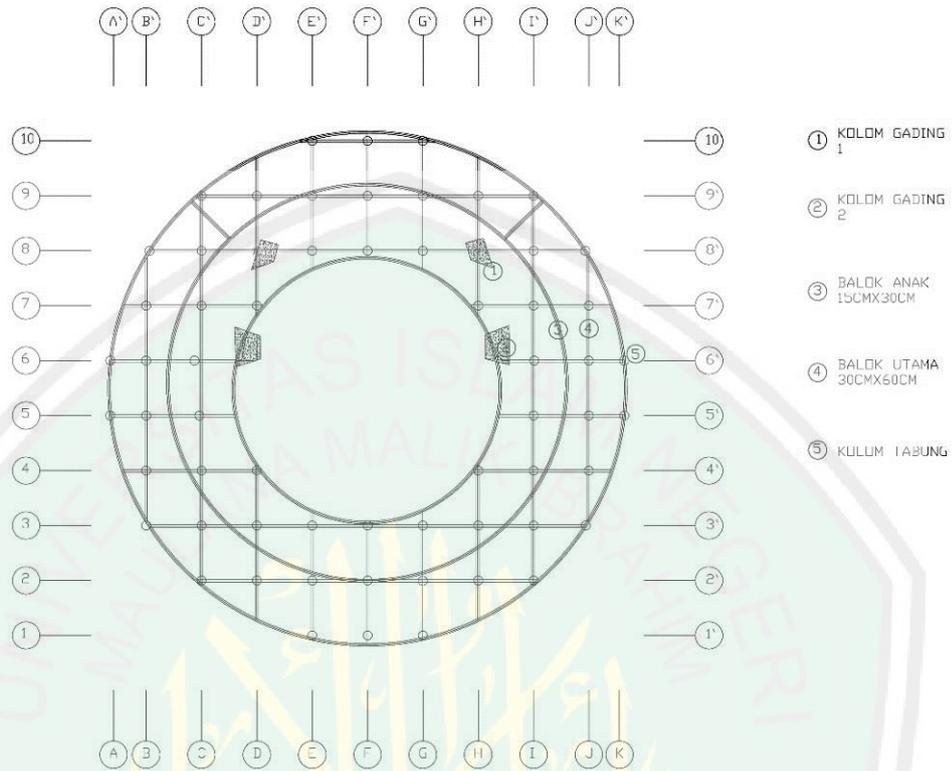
Struktur Pembalokan dan Kolom *Exhibition Center
